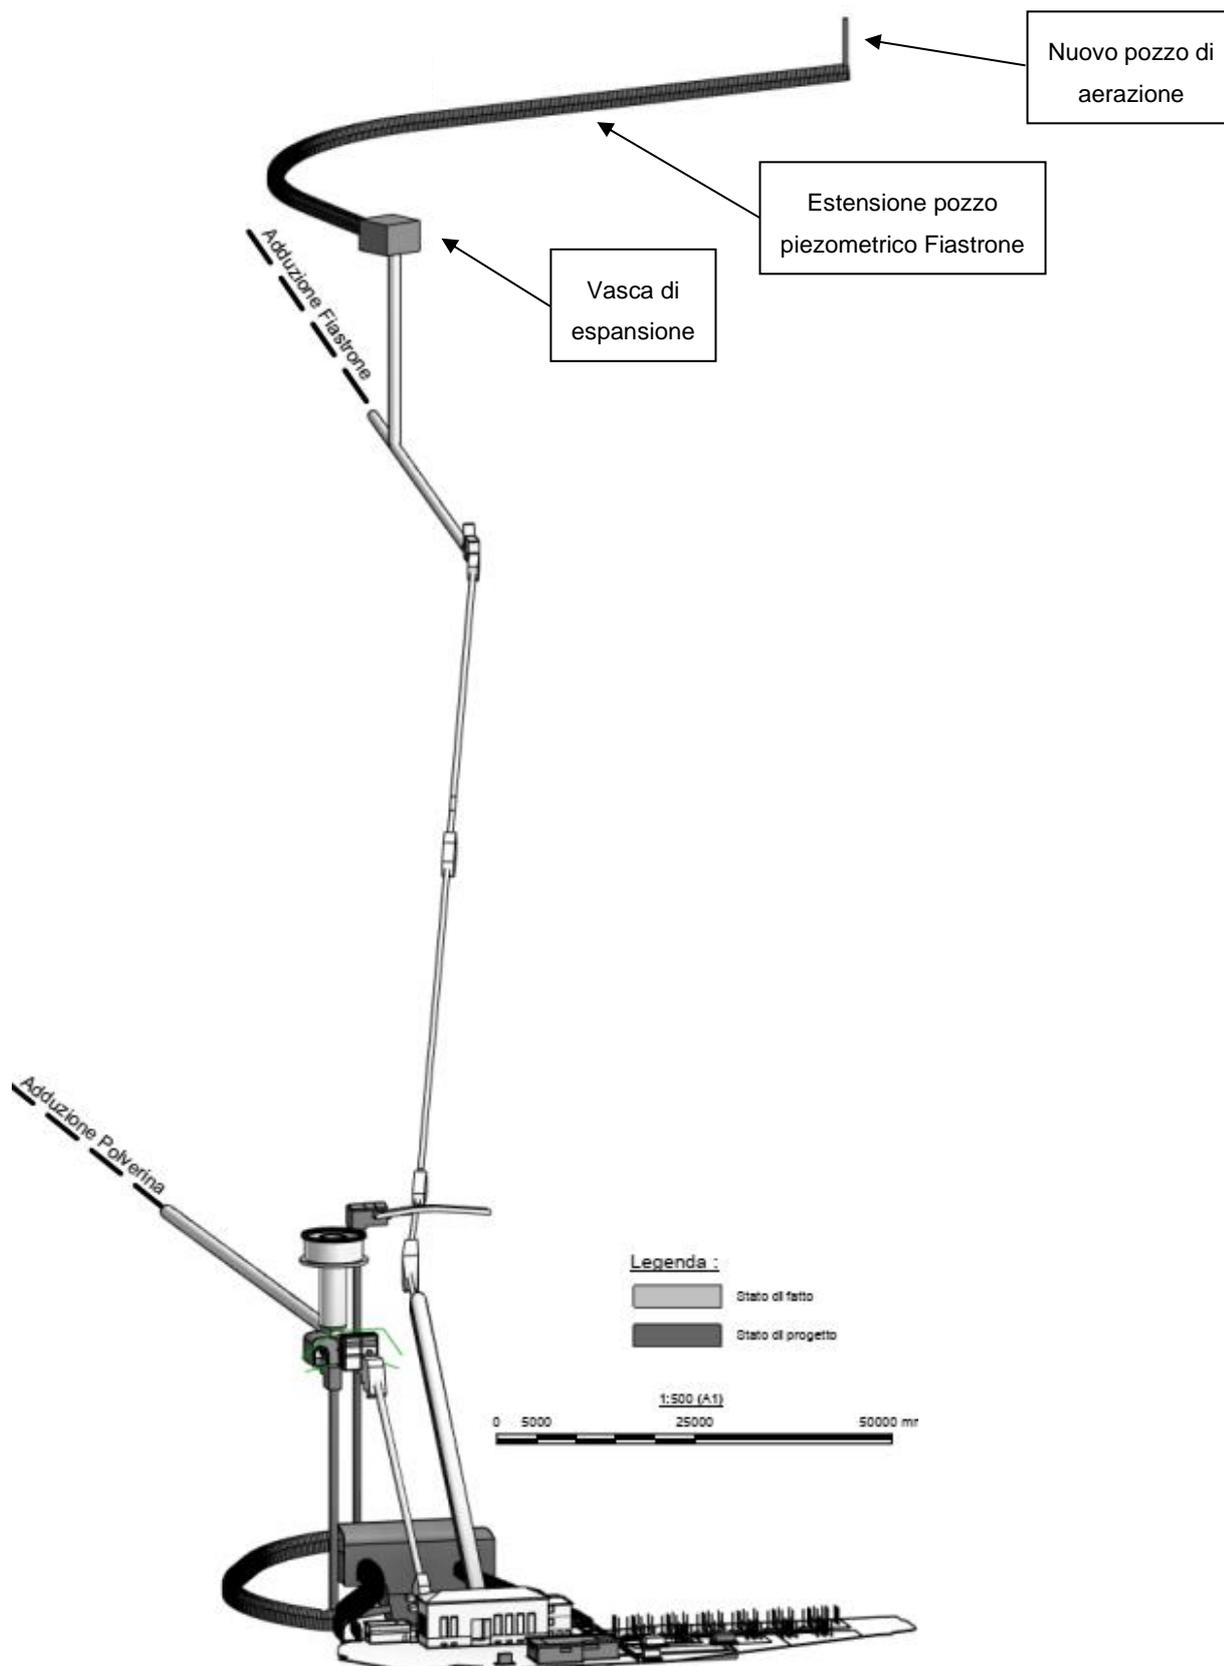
3d estensione pozzo piezometrico Fiastrone
